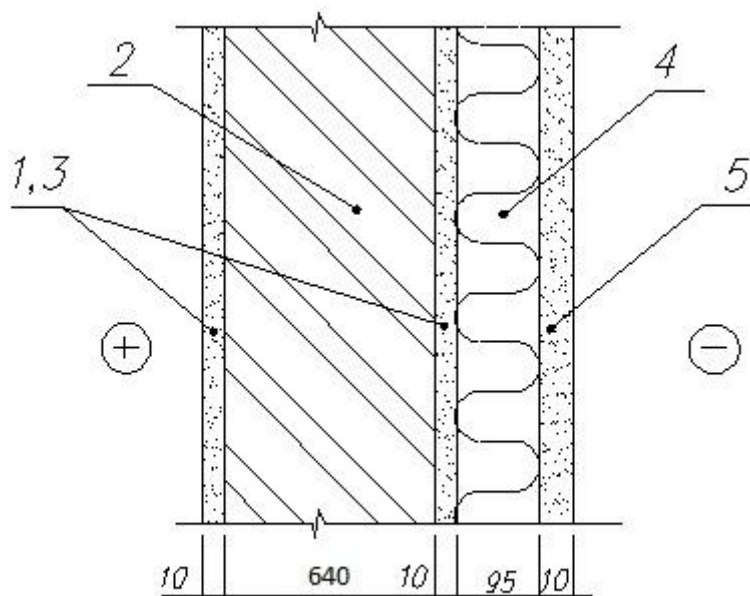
Конструкция утепления стены снаружи с использованием в качестве утеплителя плит из пенополистирола.
